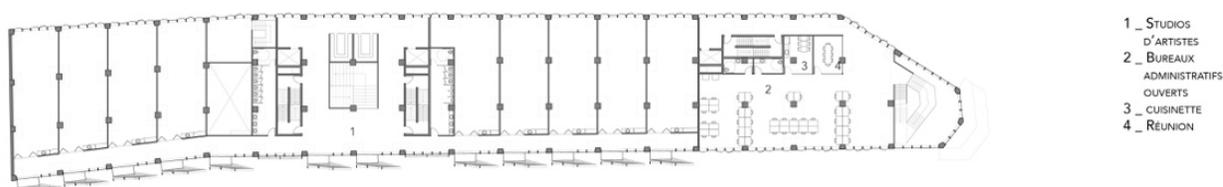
\_ Plan du 3<sup>e</sup> Étage
